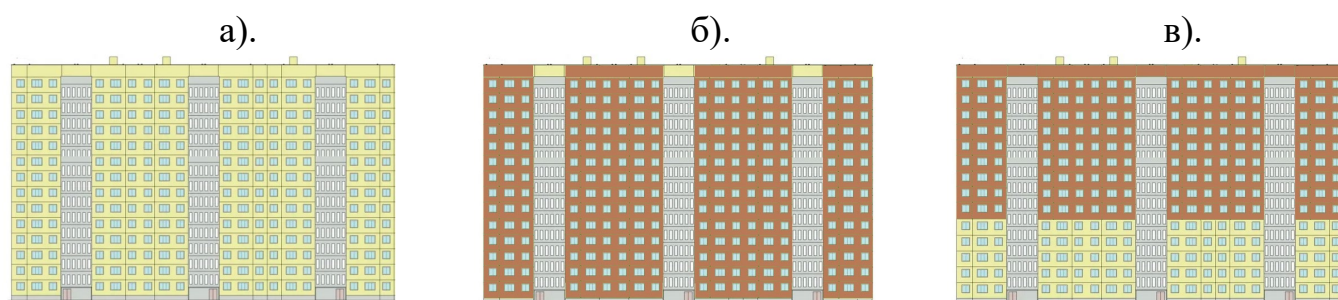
Варианты архитектурно-строительного решения инсолируемого фасада: а). «светлый»; б) «темный»; в). «смешанный»
